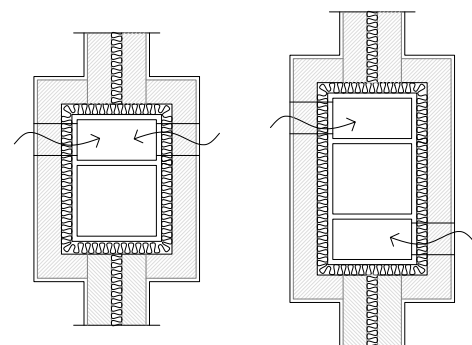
Tubería de calefacción atravesando un elemento de separación entre dos unidades de uso en un edificio existente.
